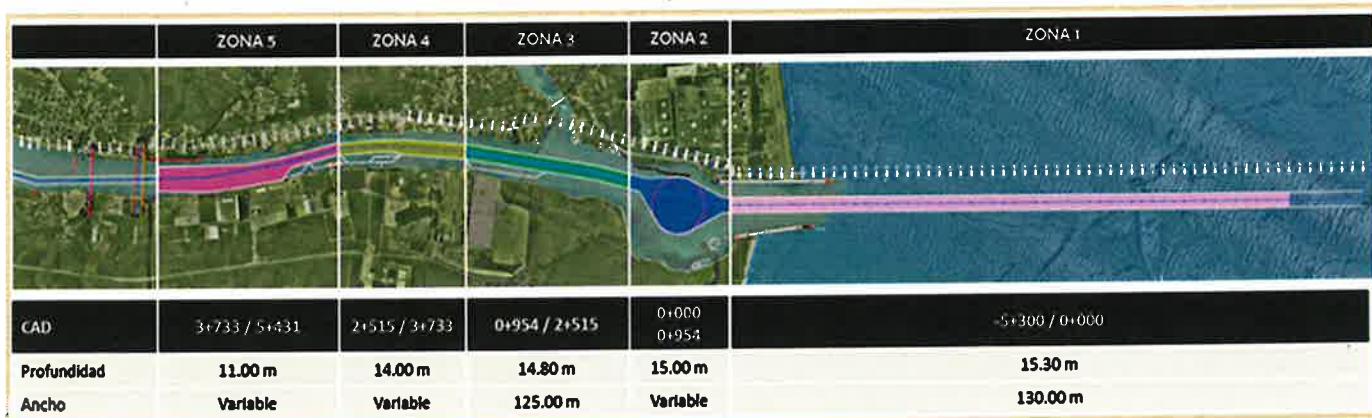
Vista en planta del Canal de Navegación donde se realizarán los trabajos.
